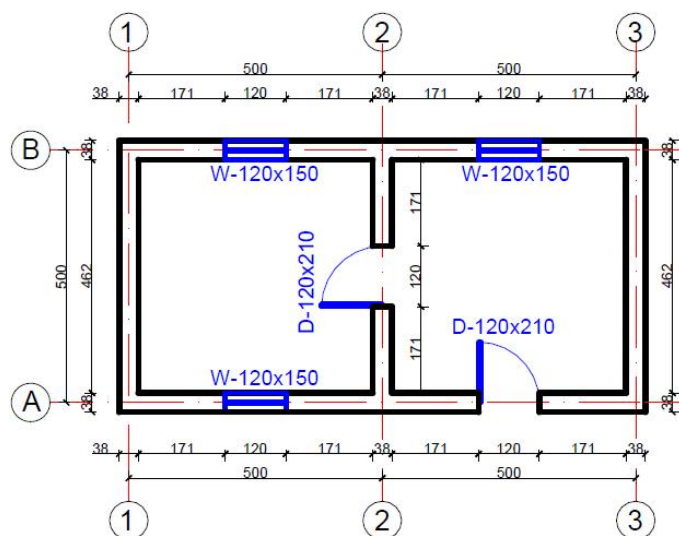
Planimetri e katit përdhe të strukturës së testuar.
